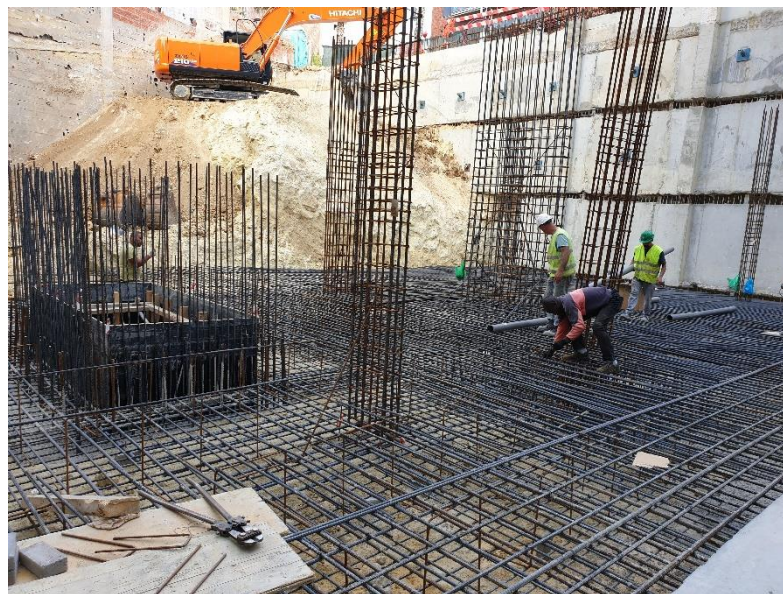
Espaçadores em aço e cofragem na caixa de elevador
